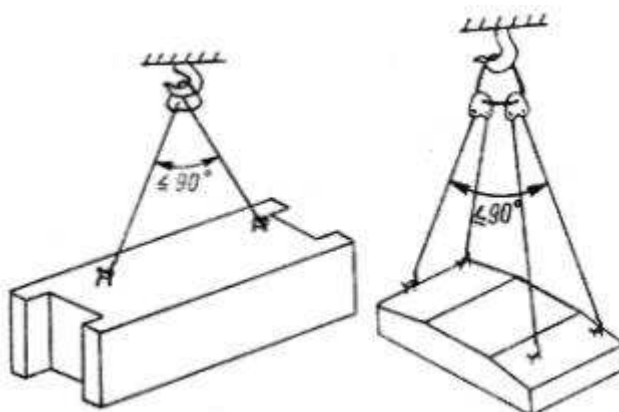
Схема строповки фундаментных блоков и плит
